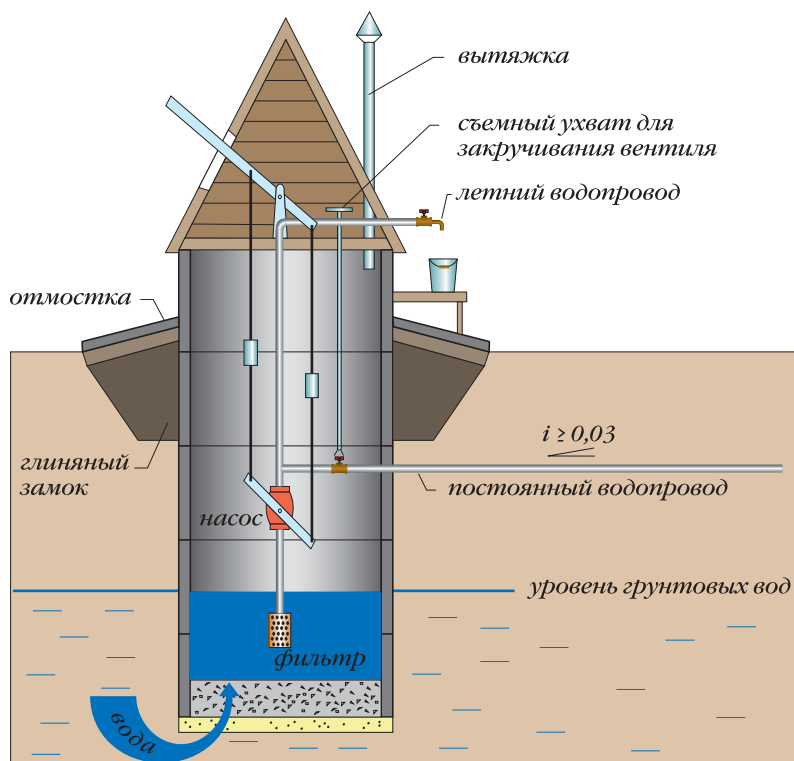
Водоснабжение из железобетонного колодца с закачкой воды ручным насосом
